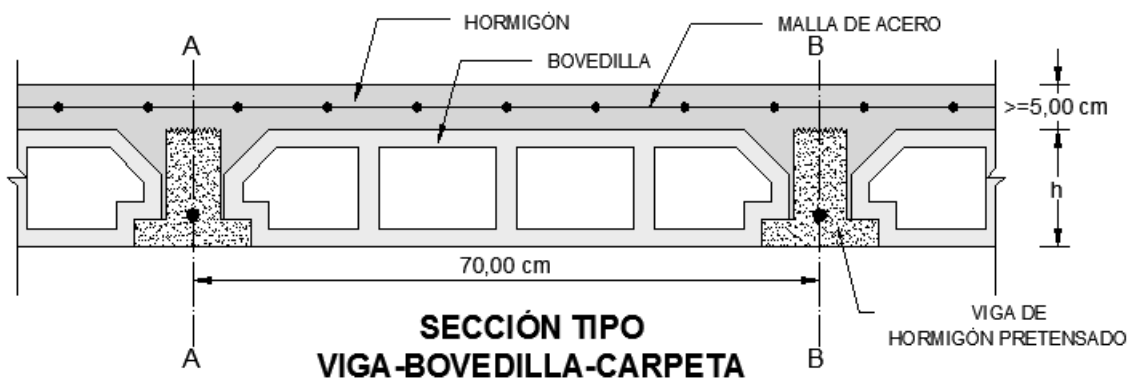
Sección Tipo Viga-Bovedilla-Carpeta.
